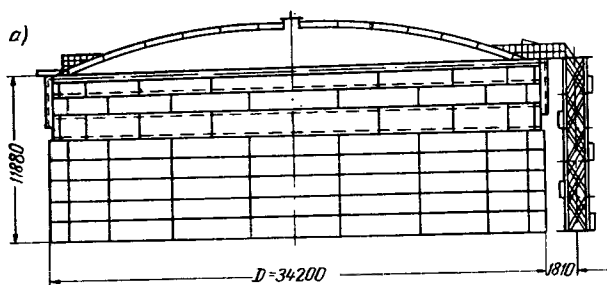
Вертикальный цилиндрический резервуар емкостью 10 000 м³ без центральной стойки со сферической кровлей
